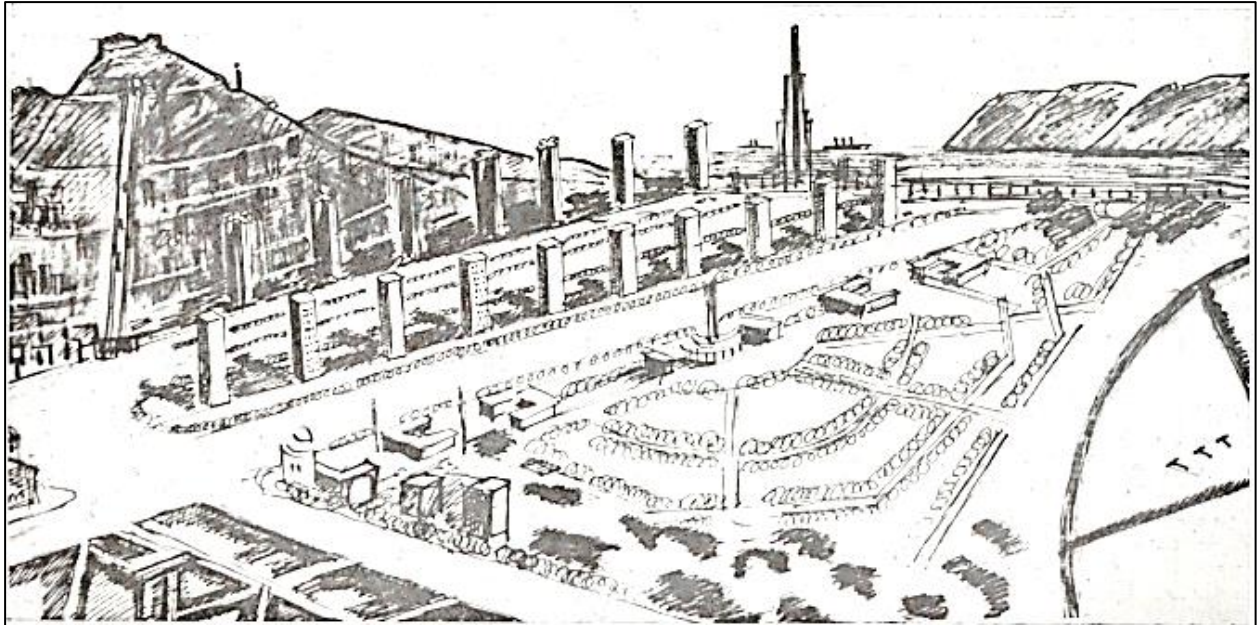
Croquis du nouveau projet centre urbain à Oran publié sur la revue chantiers 1937. (Source : Les Chantiers nord-africains, 1937)
